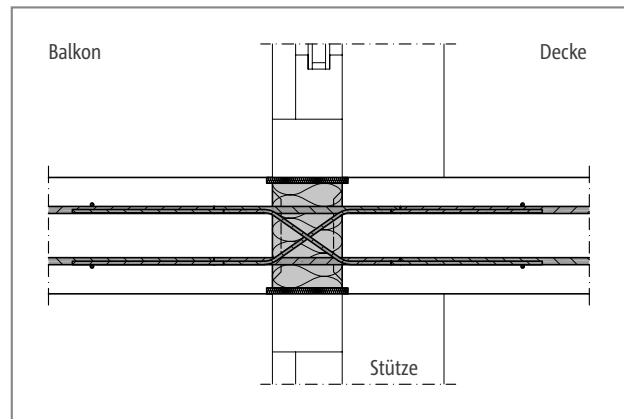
Schöck Isokorb® XT Typ D: Einbauschritt; Flachdecke
